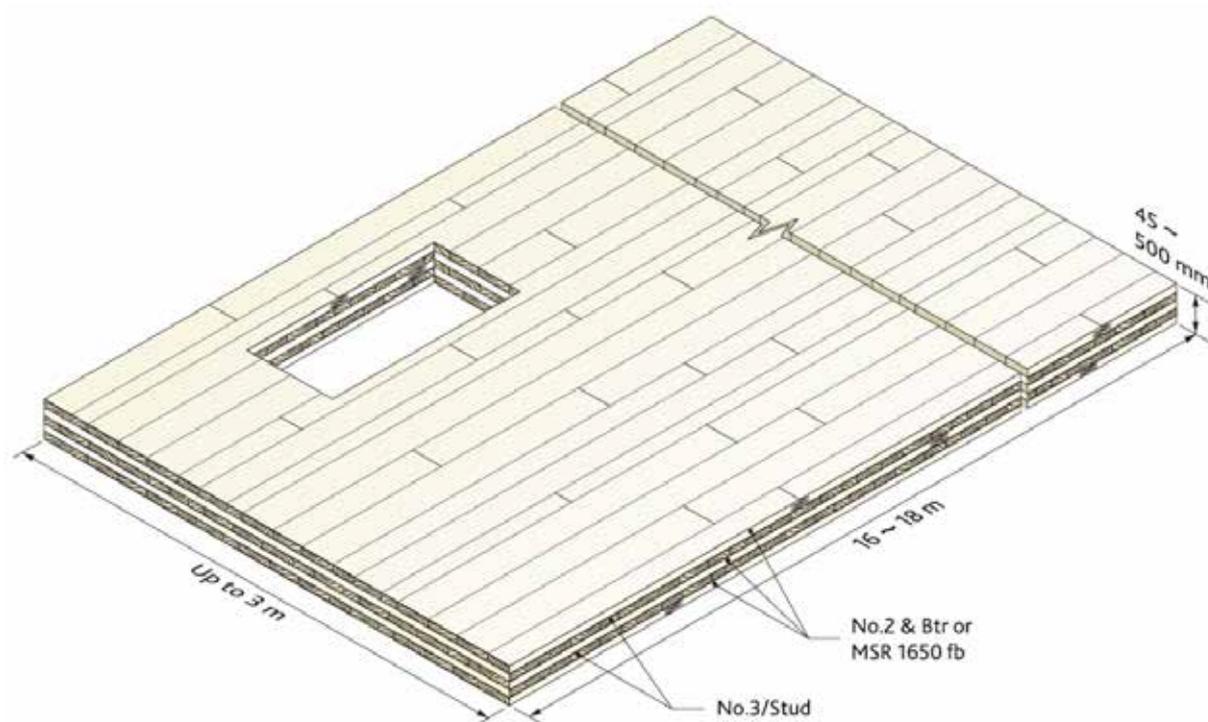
SCHÉMA D'UN ÉLÉMENT DE PLANCHER EN CLT [FPIINNOVATIONS]
